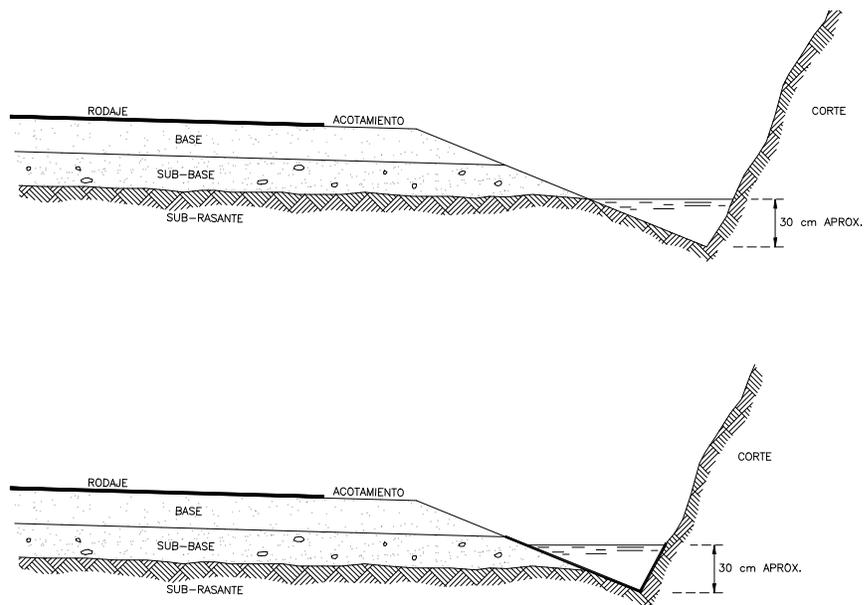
DISPOSICIÓN MÁS CONVENIENTE DE LA CUNETA RESPECTO AL PAVIMENTO.
